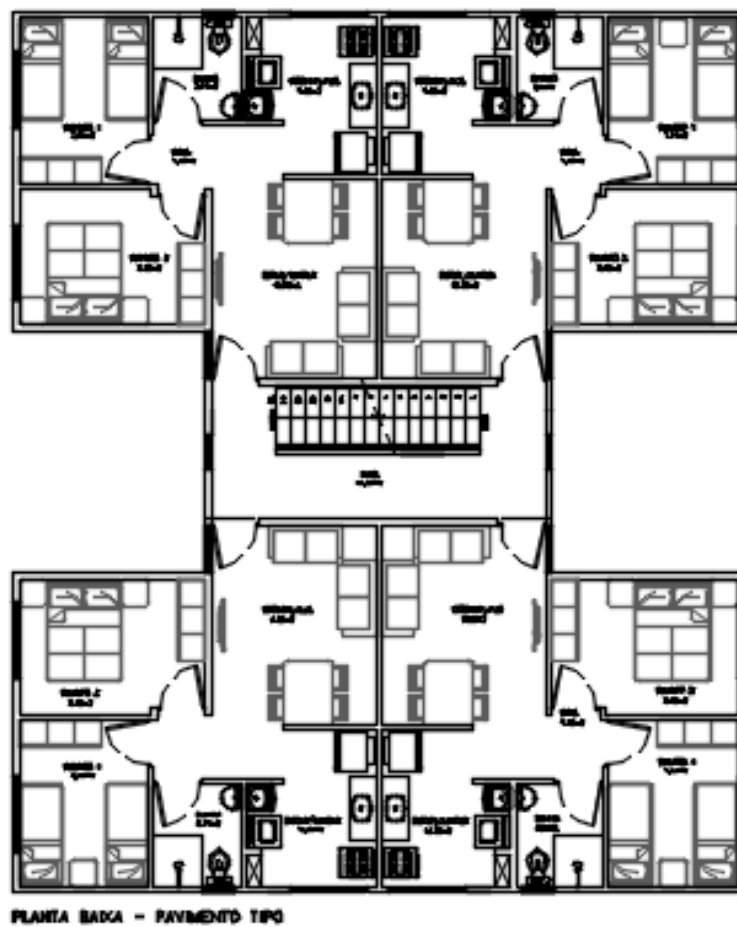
Planta do pavimento tipo do Empreendimento A.
